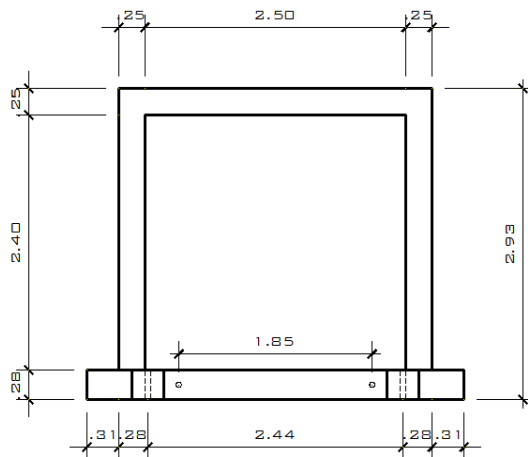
2 Detalles geométricos del pórtico de concreto armado (Fuente: Sáenz, 2016).
